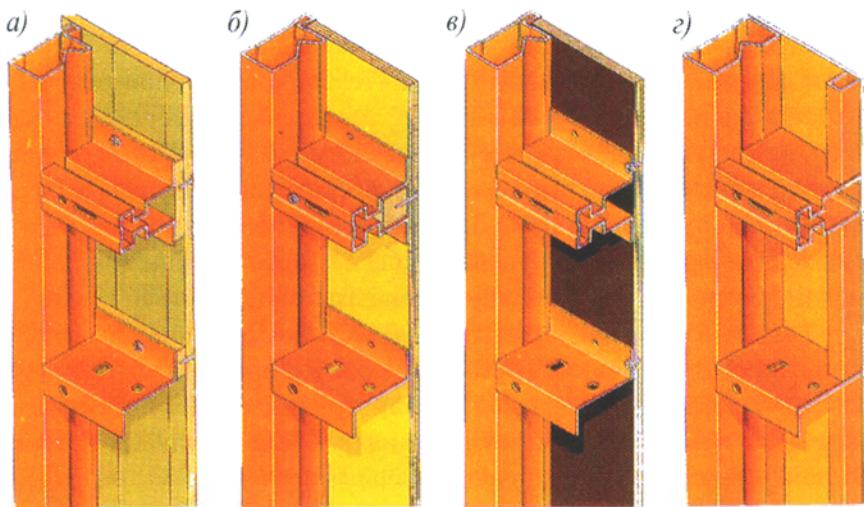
Щиты опалубки: а - щит из цельной древесины; б - щит из фанеры толщиной 22 мм; в - щит из фанеры толщиной 21 мм; г - щит из фанеры толщиной 10 мм
